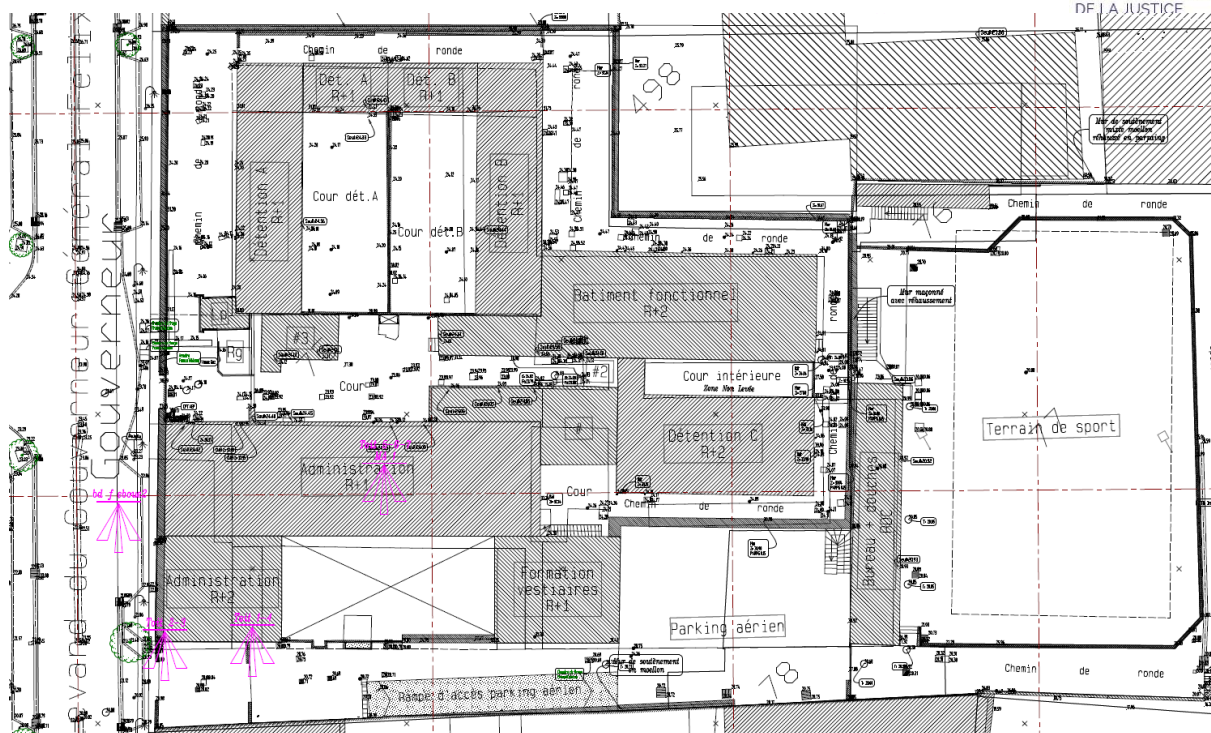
Plan masse des constructions de la Maison d'Arrêt historique
